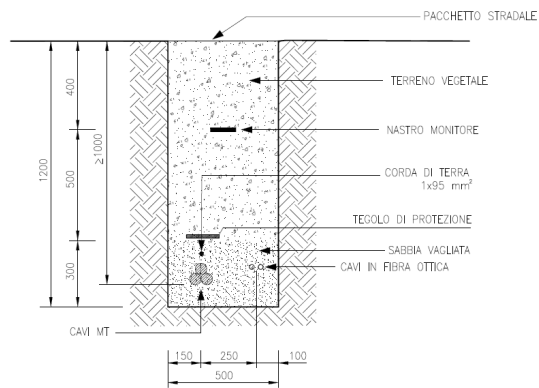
Sezioni di posa cavidotti su strada di progetto
